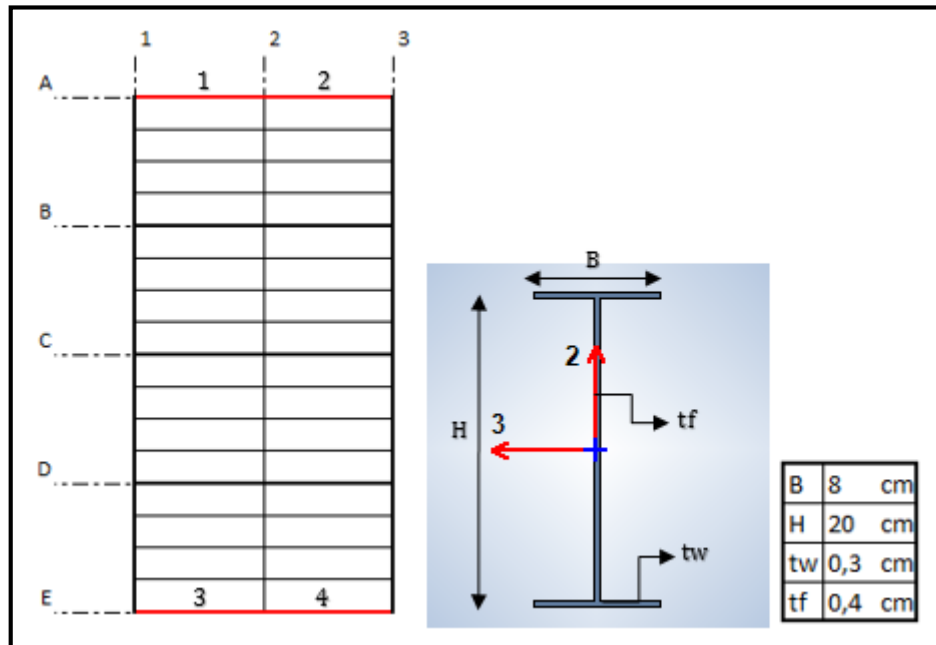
Dimensiones de vigas perimetrales en "X" con pórticos arriostrados.
